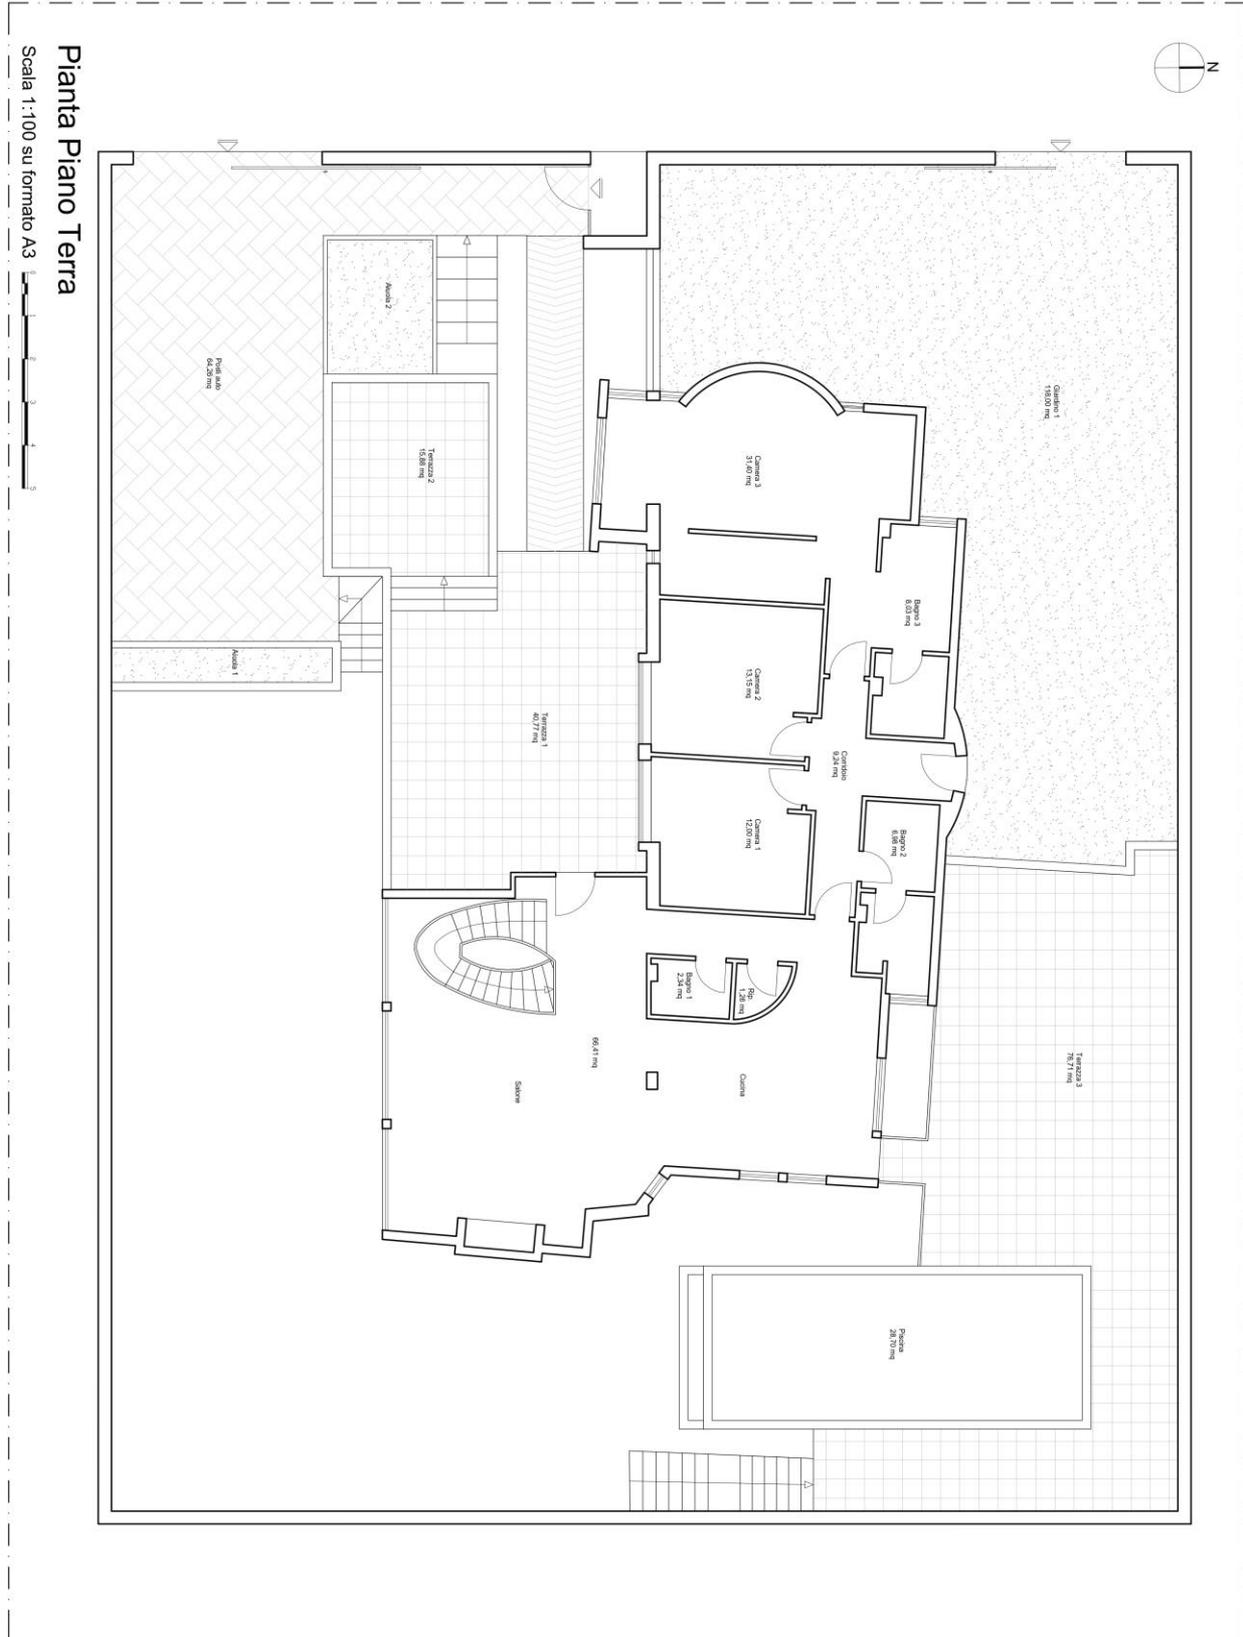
Planimetria dello stato di fatto – pianta piano terra
